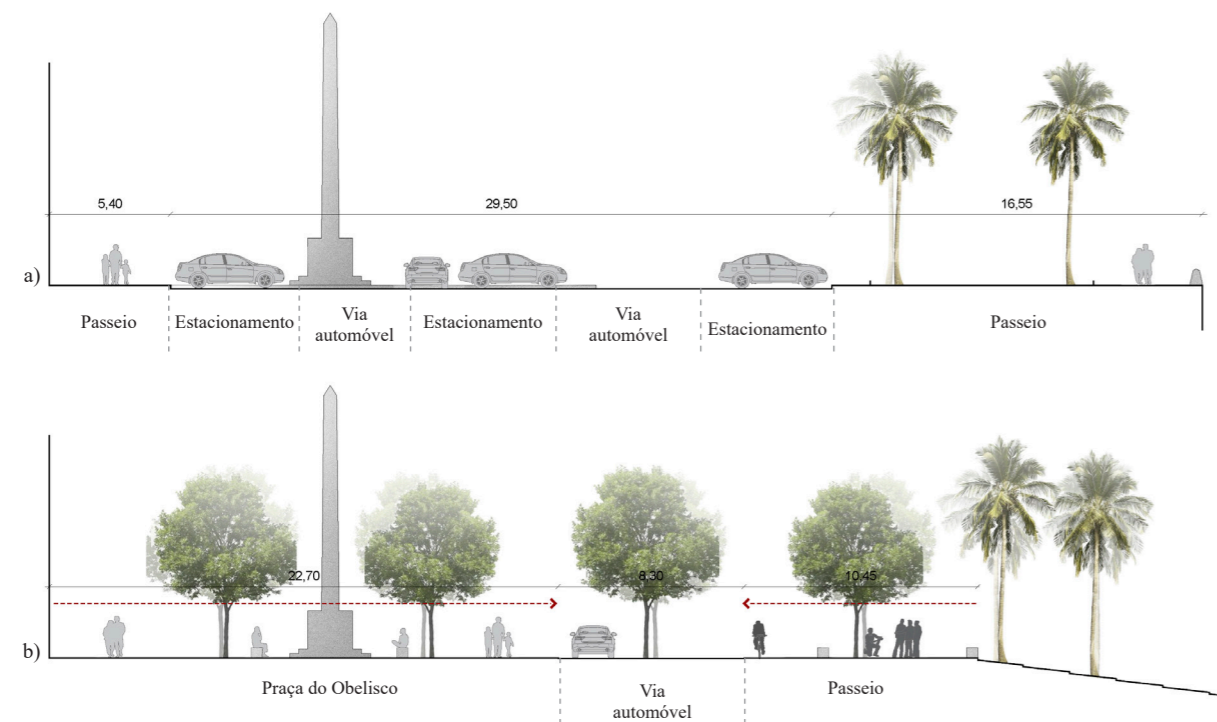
Corte cc'. Esquema de intervenção - Existente e Proposta
